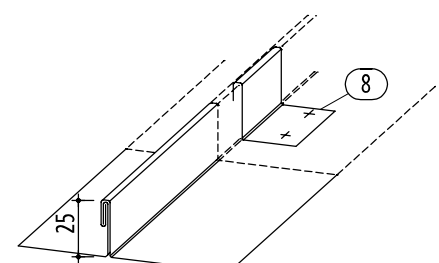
Detail zu Bild 5.3, Befestigung mit Schiebehaf
